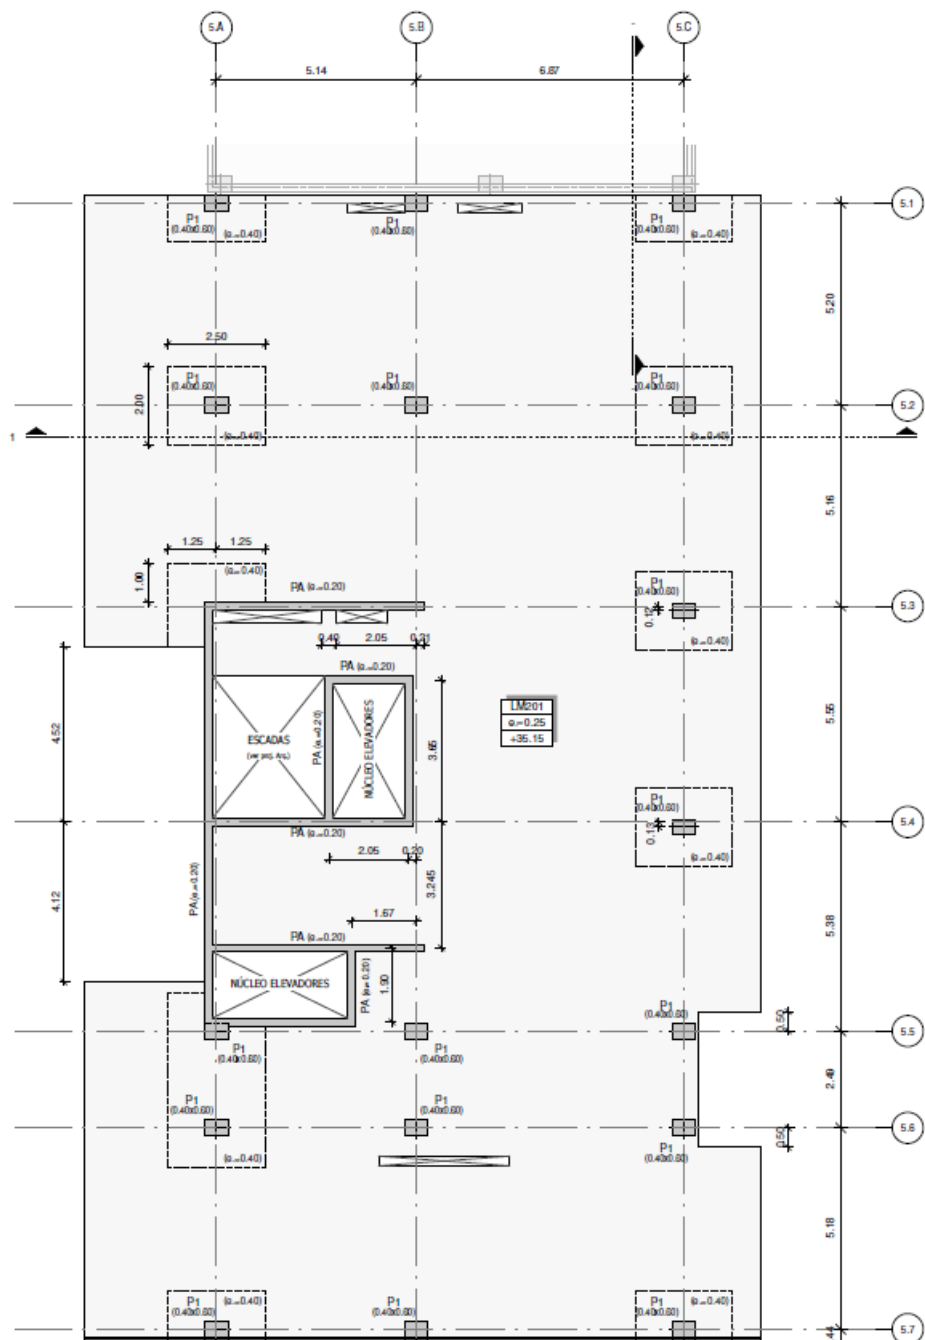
Planta estrutural Piso Tipo 2 (Revit)
